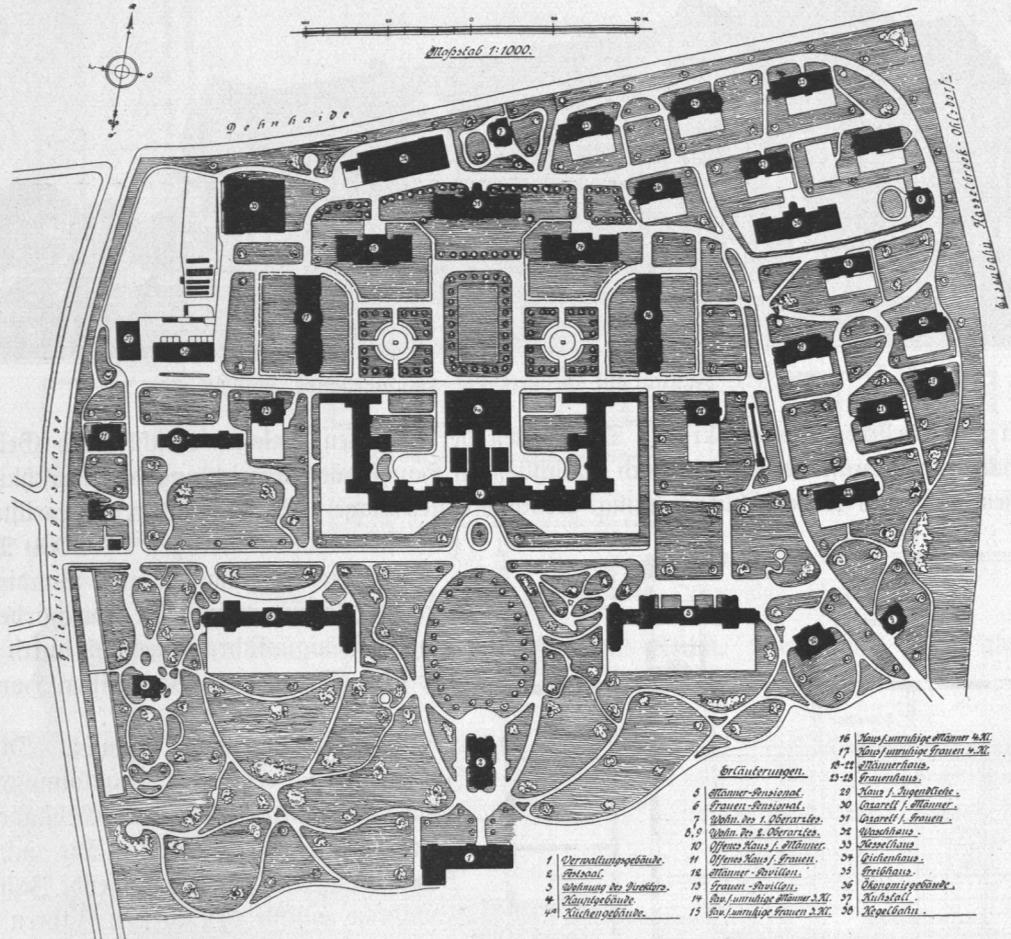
Irrenanstalt Friedrichsberg, Lageplan.
